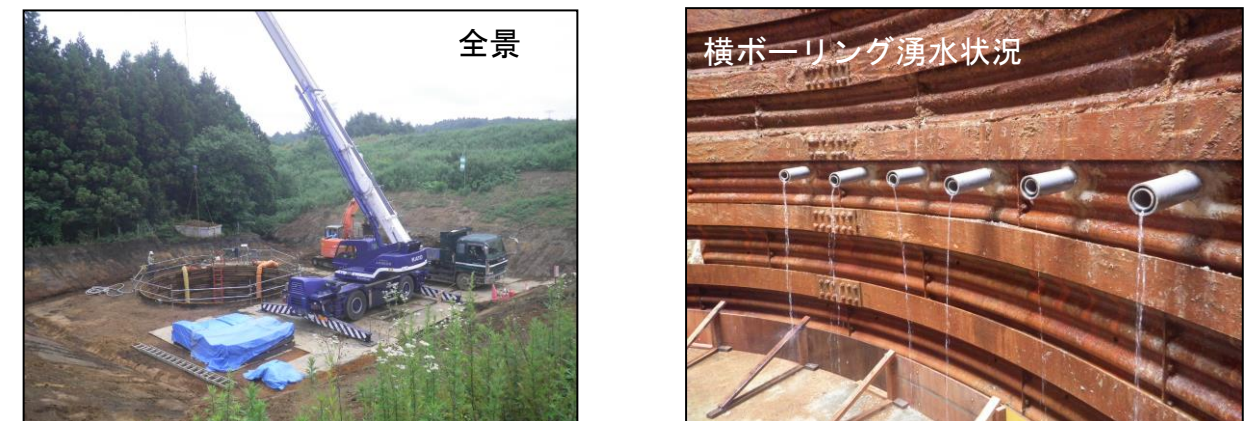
J 地区既設ライナープレートからの横ボーリング設置状況
